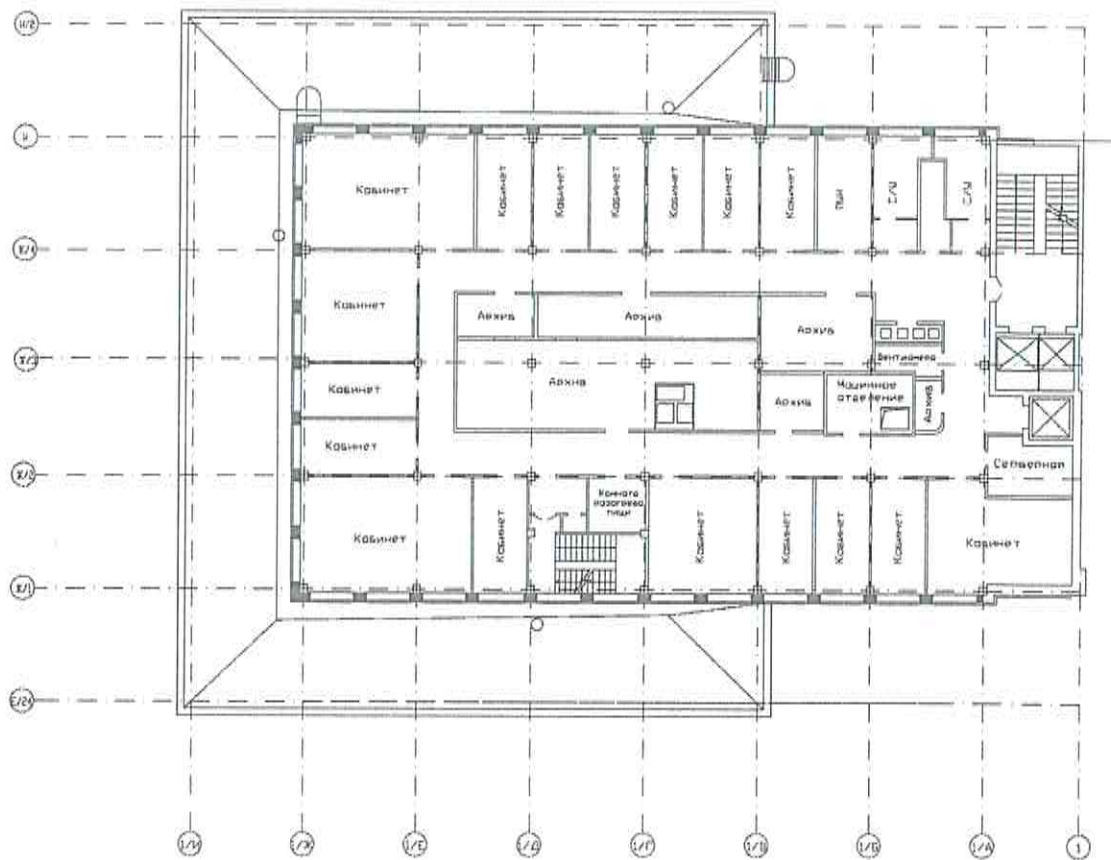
Предварительная планировка 4-го этажа АБЧ
